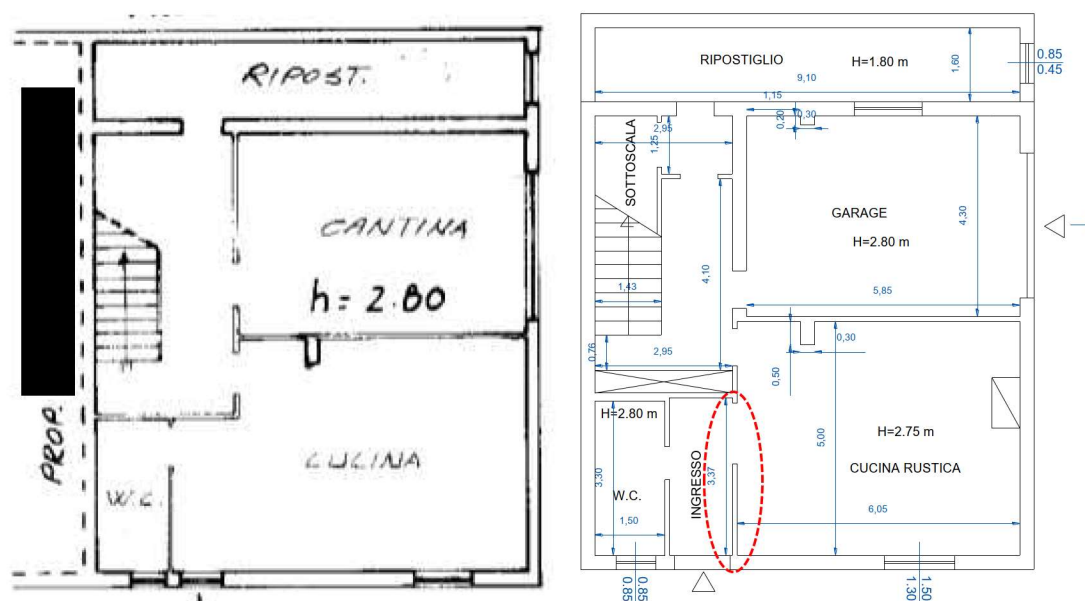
Raffronto planimetria catastale (a sinistra) e planimetria stato di fatto (a destra) - Piano seminterrato
